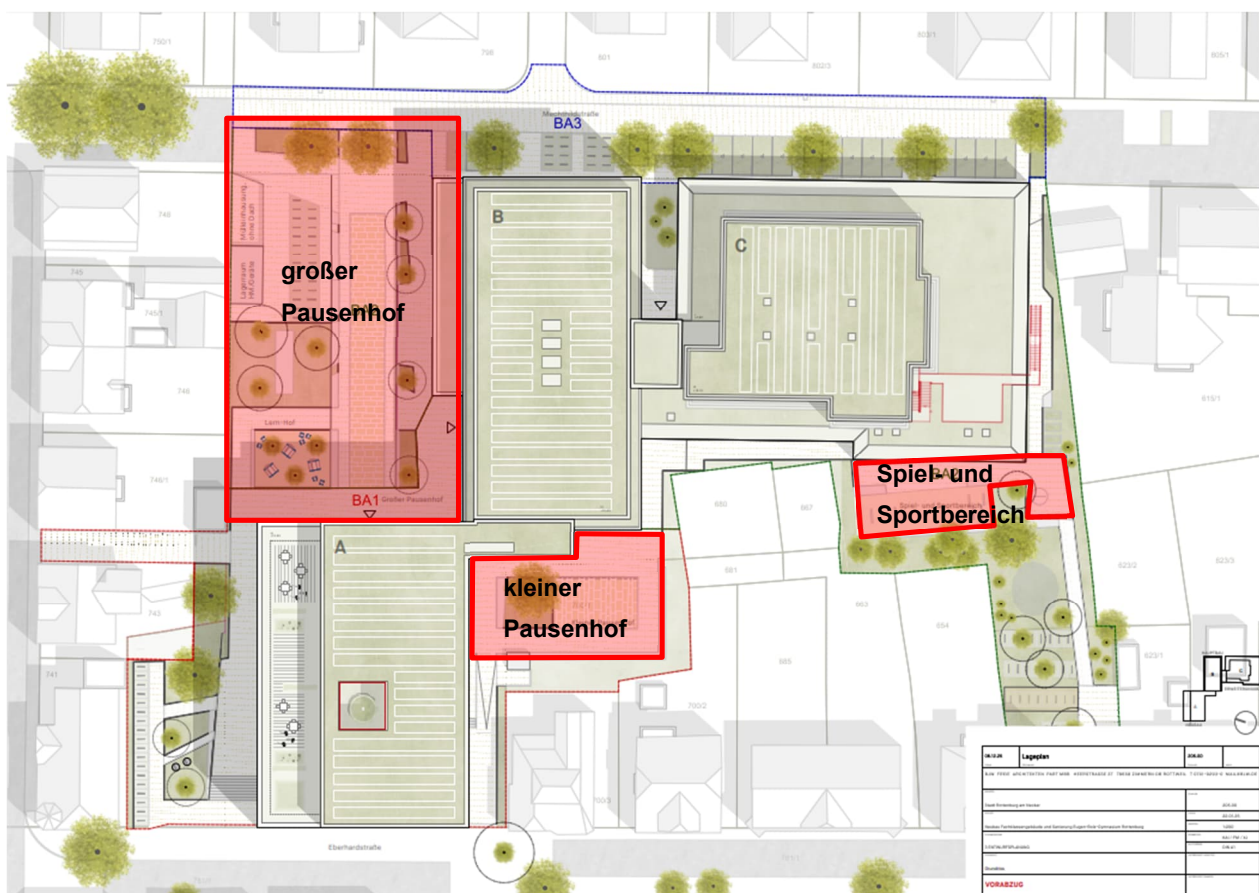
Lageplan mit Kennzeichnung der Pausenhöfe
